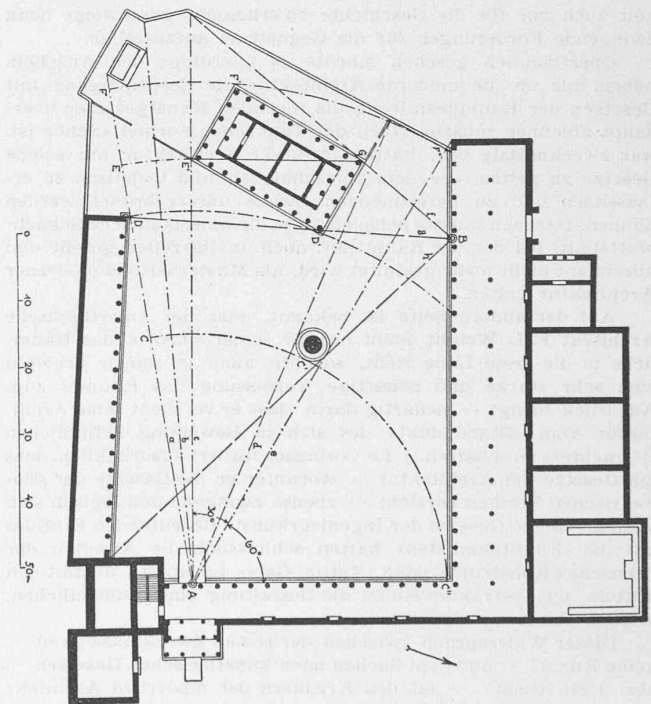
Grundriss der Athenaterrasse in Pergamon, 1 : 1000
